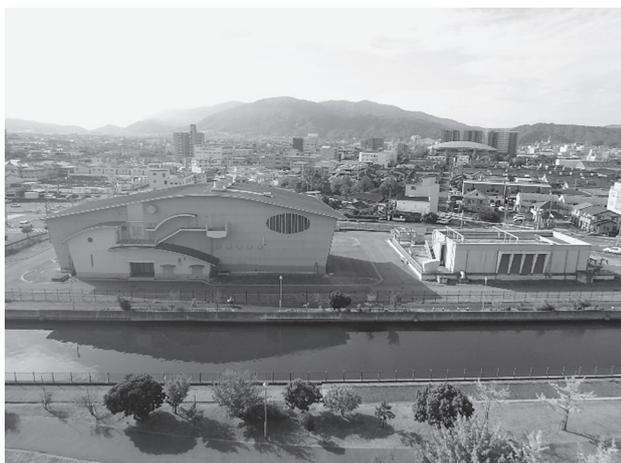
中央ポンプ場（左）と中央雨水滞水池（右）
